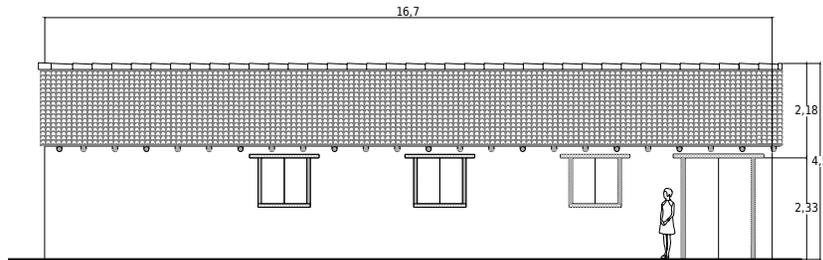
FACHADA PRINCIPAL DE LA VIVIENDA TIPO.
